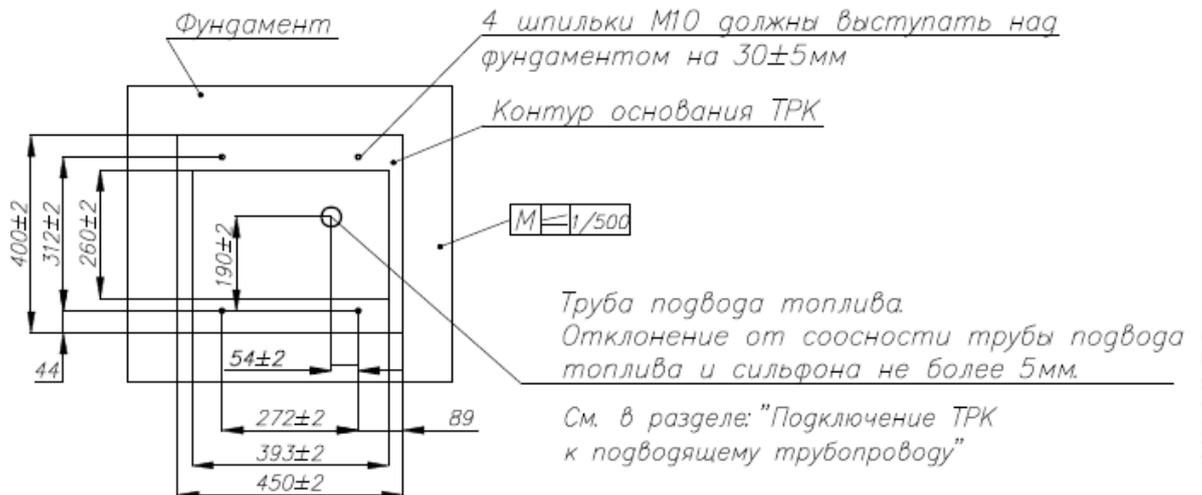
Габаритные, присоединительные, установочные размеры и установка колонки на фундаменте
